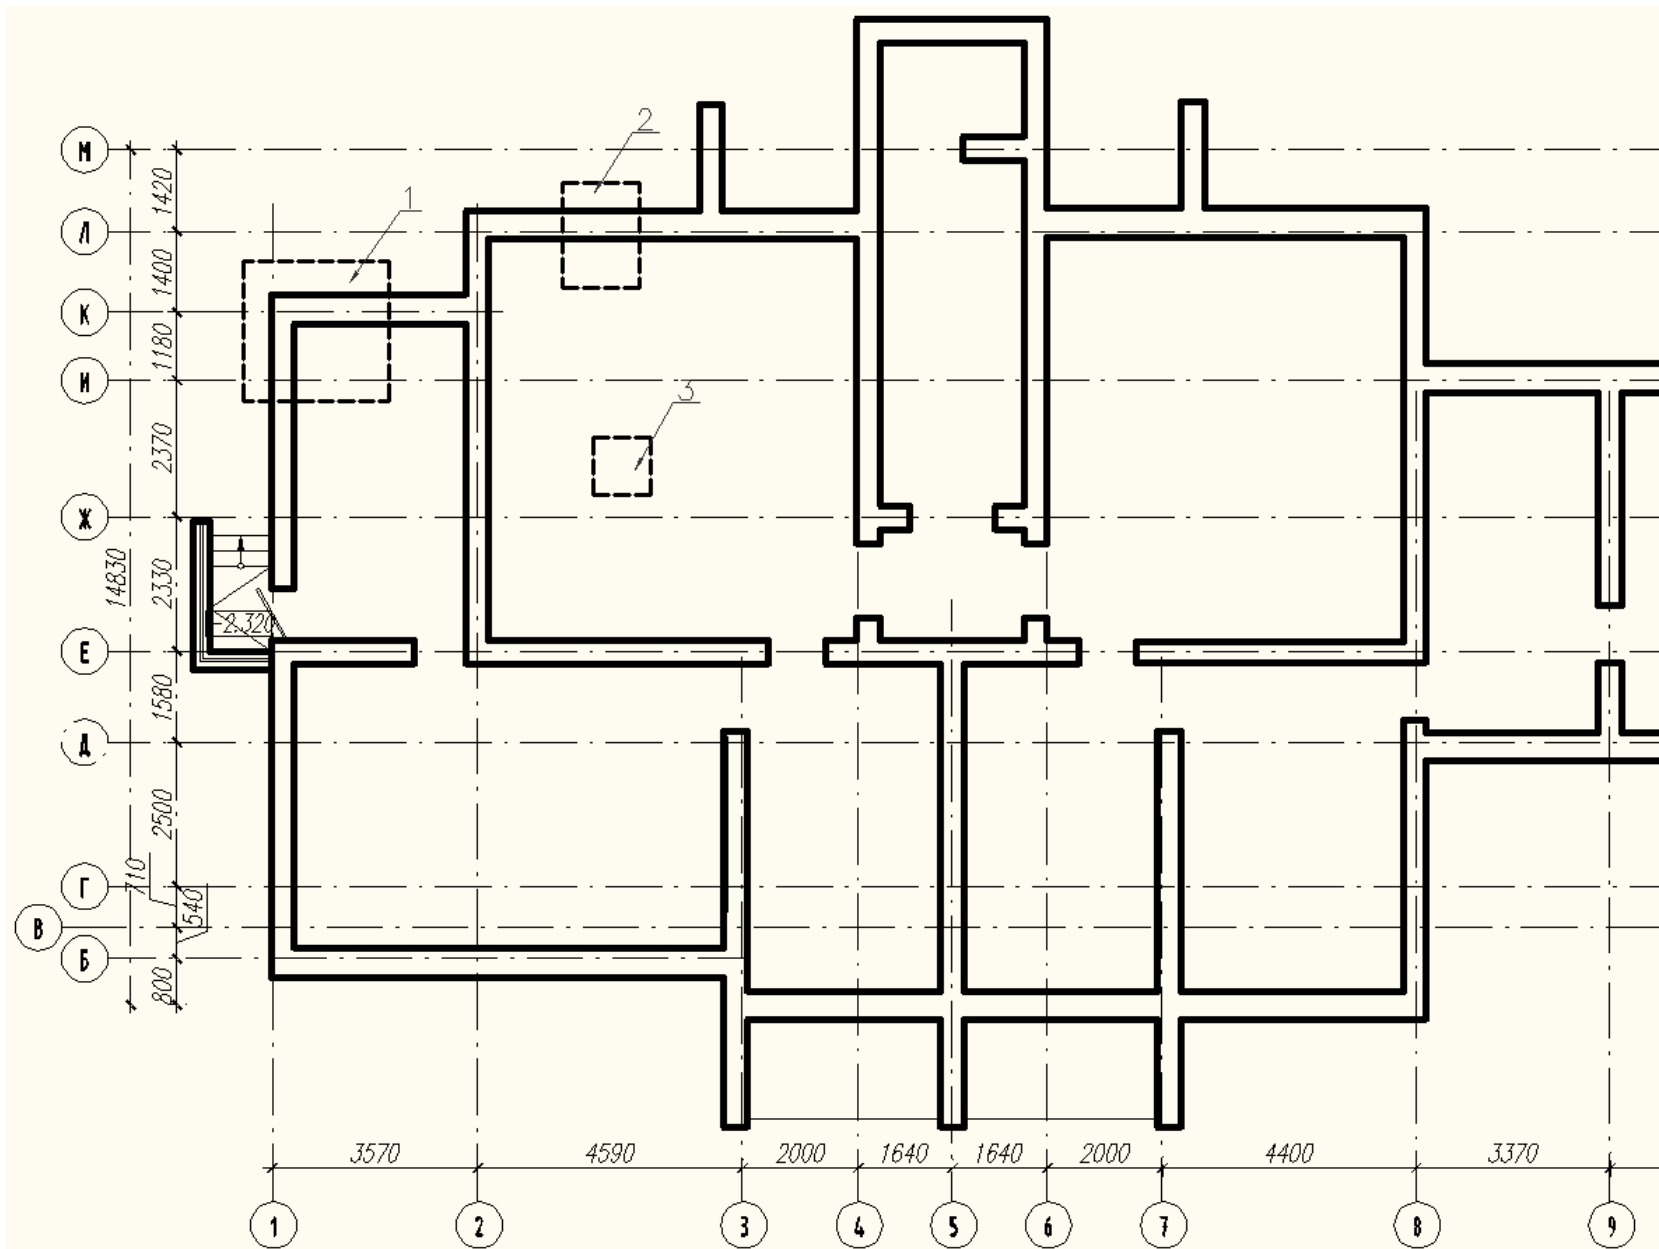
Пример разбиения наружных стен цокольного этажа на расчетные участки
